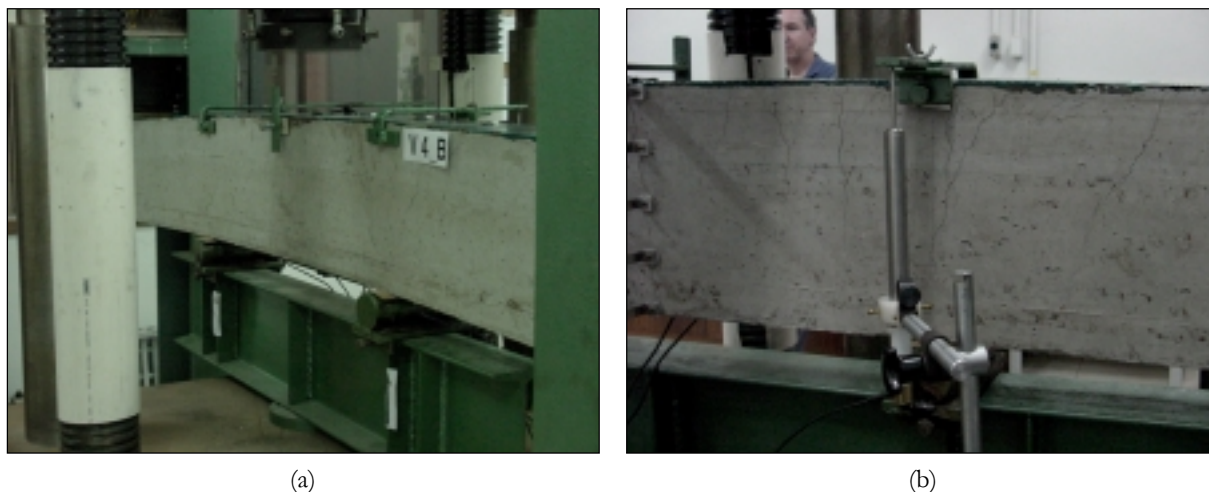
Deslocamento vertical e fissuração da viga V4_B
